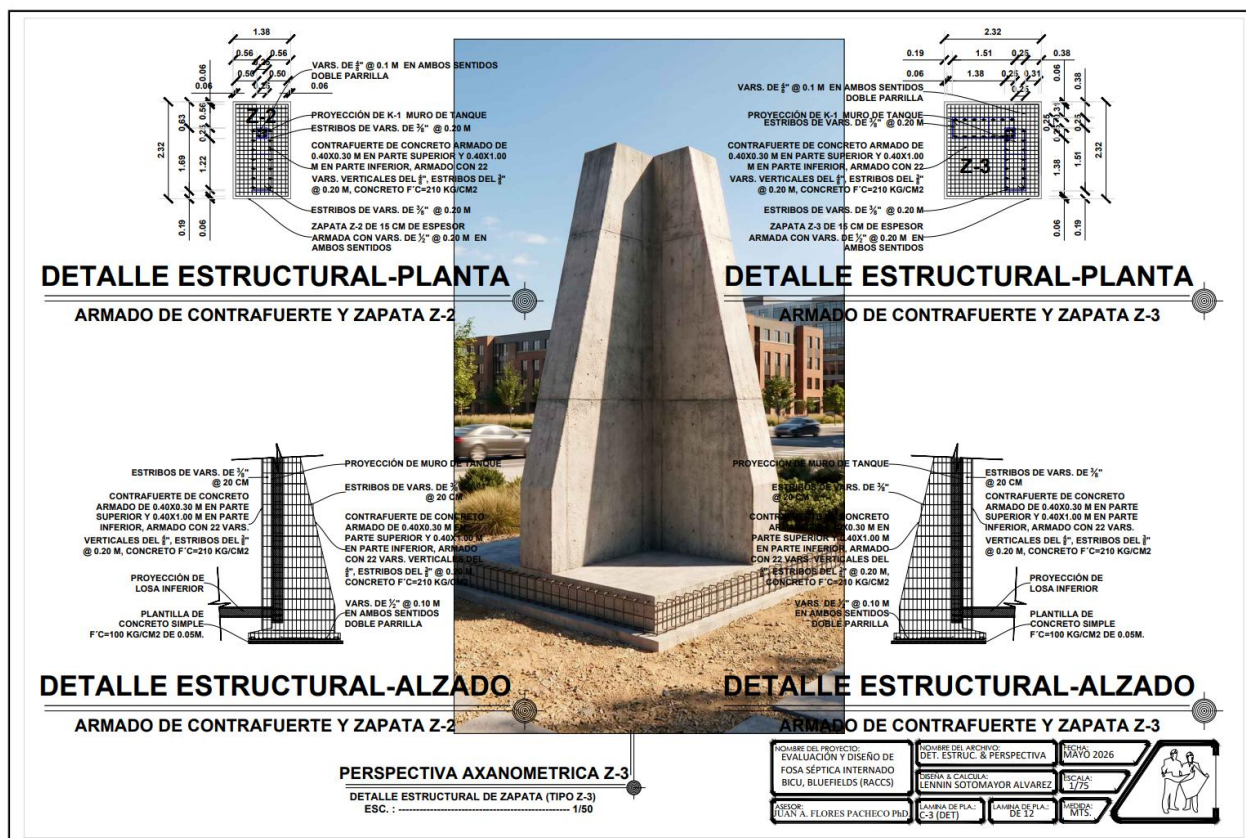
Detalles estructurales de contrafuertes y zapatas Z-2 y Z-3 para la alternativa en concreto reforzado del sistema séptico del internado de BICU.
